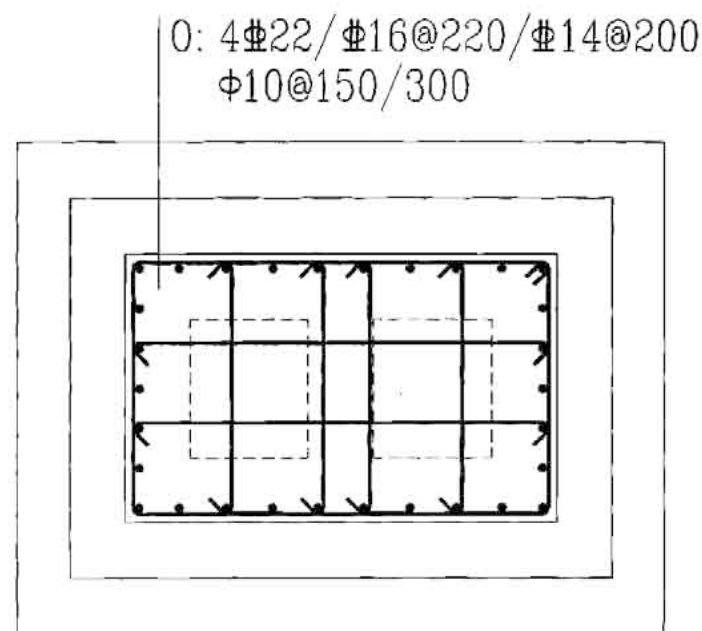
双高杯口独立基础杯壁配筋示意
